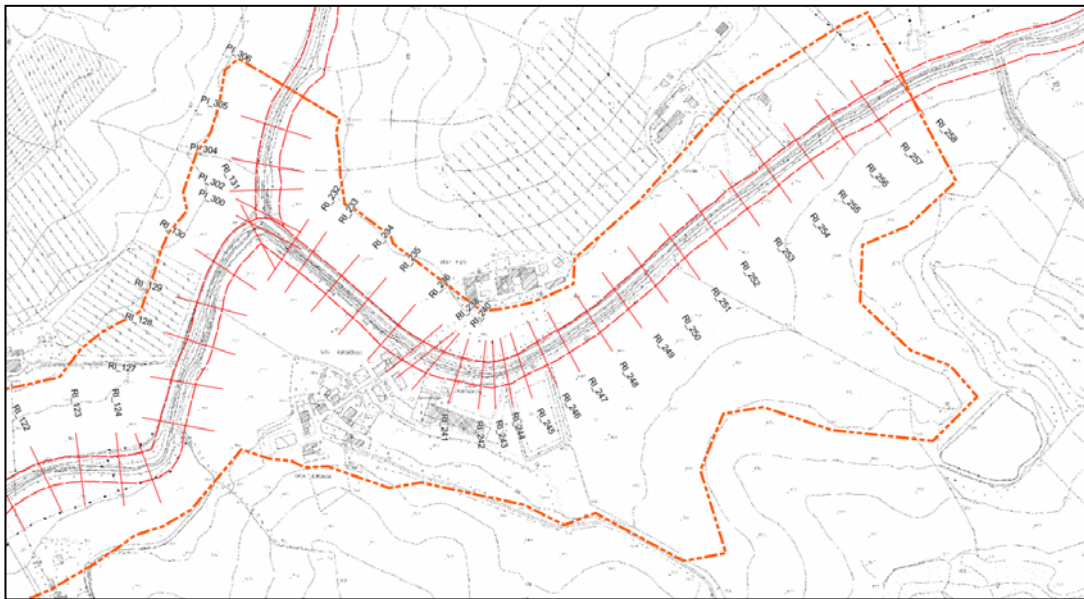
Planimetria sezioni Torrente Riofi – tratto estensione verso monte.
